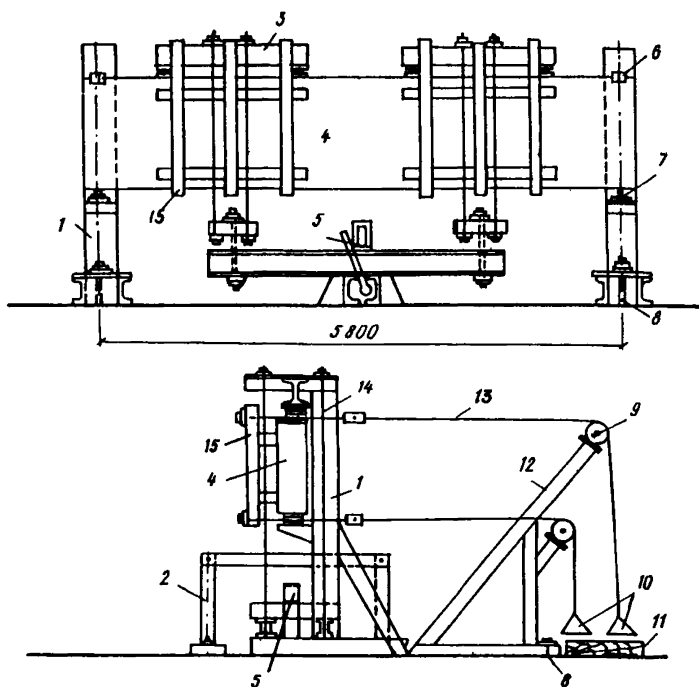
Схема стэнда для испытания наружных стеновых панелей при действии горизонтальных и вертикальных нагрузок
